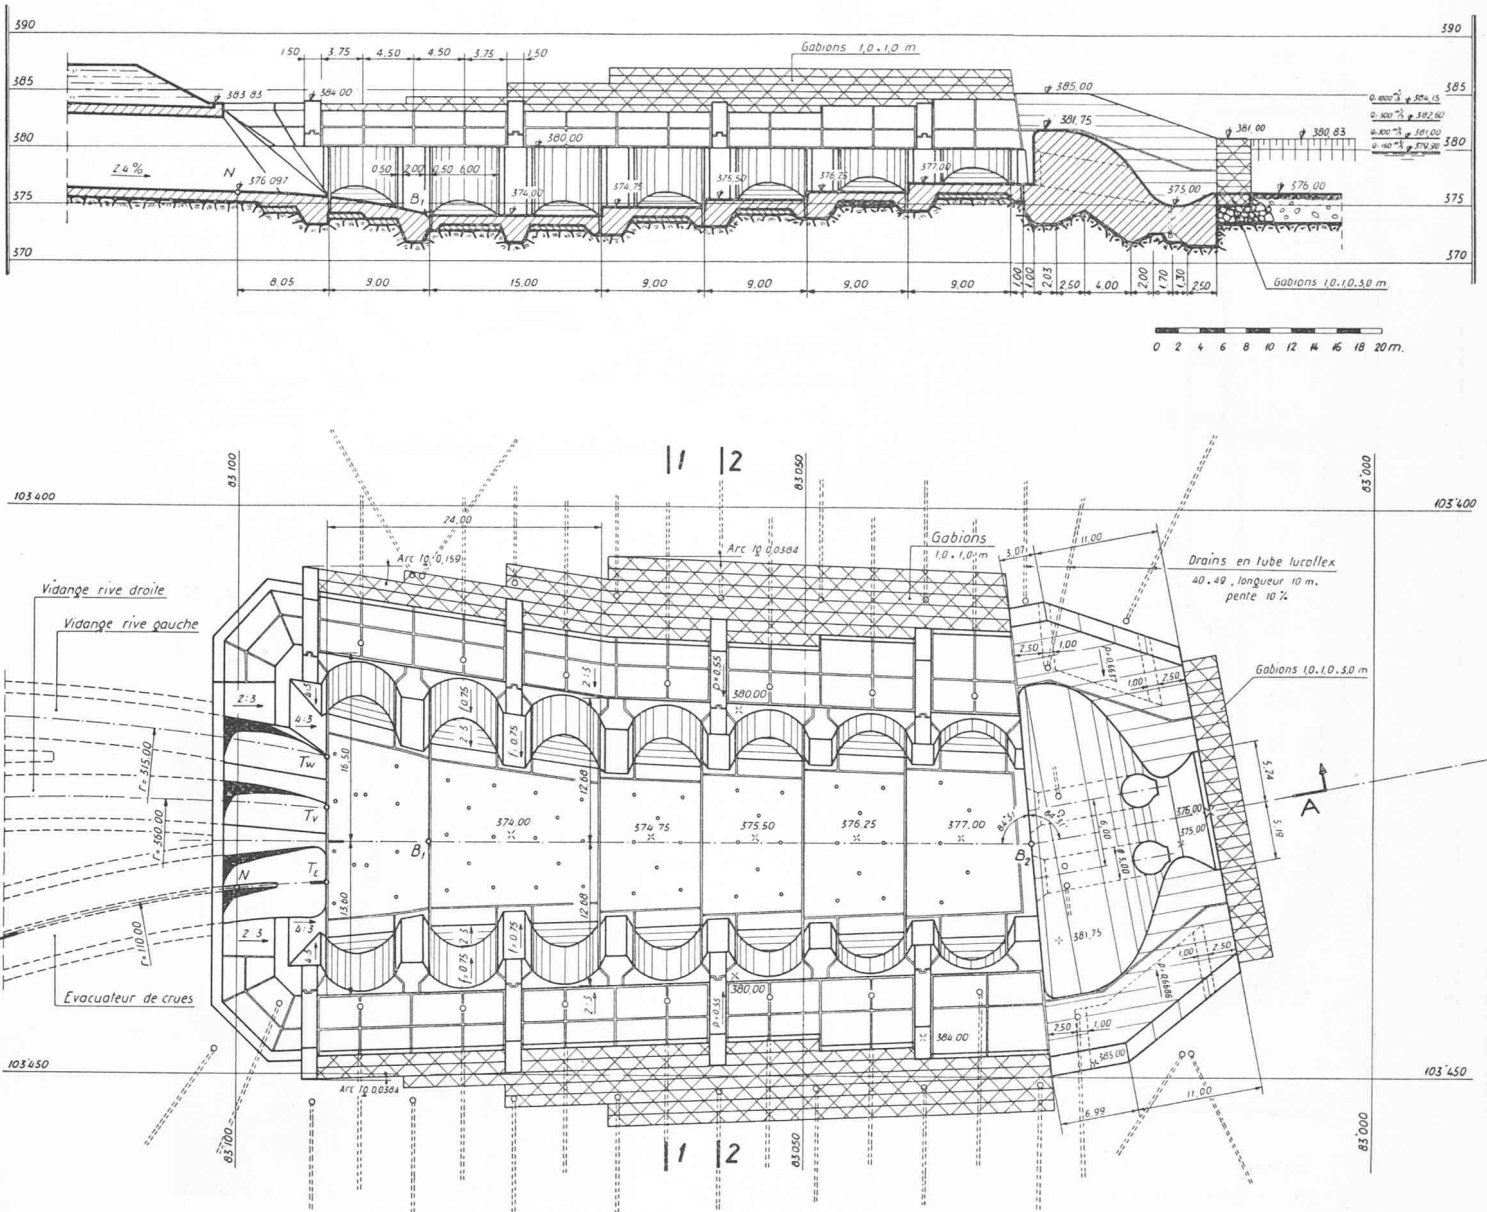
Bassin amortisseur. — Profil en long (coupe A—A) et plan de situation.
